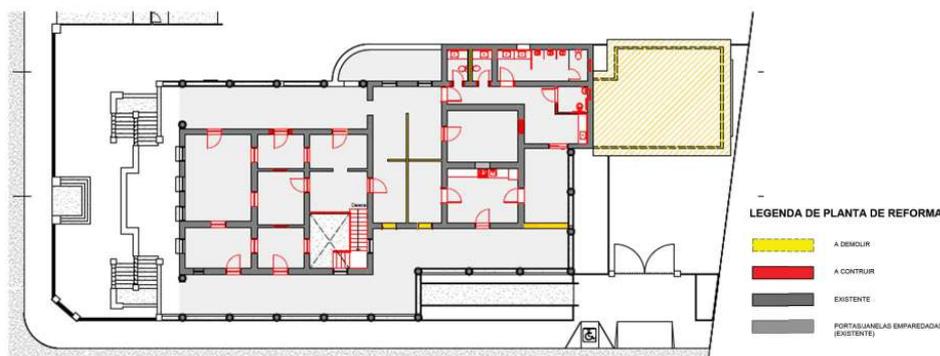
Planta Baixa de Reforma Térreo Casarão
